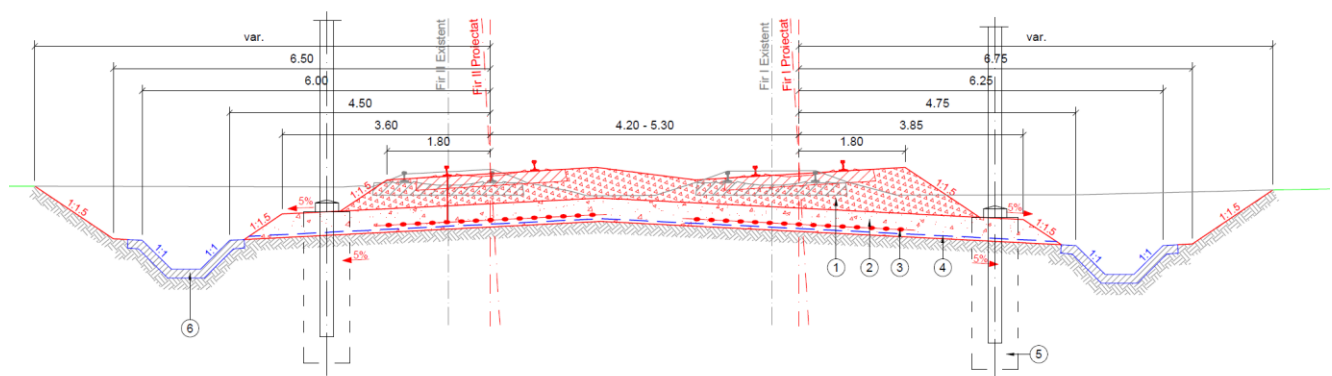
Profil transversal tip în debleu cu șanțuri din beton
